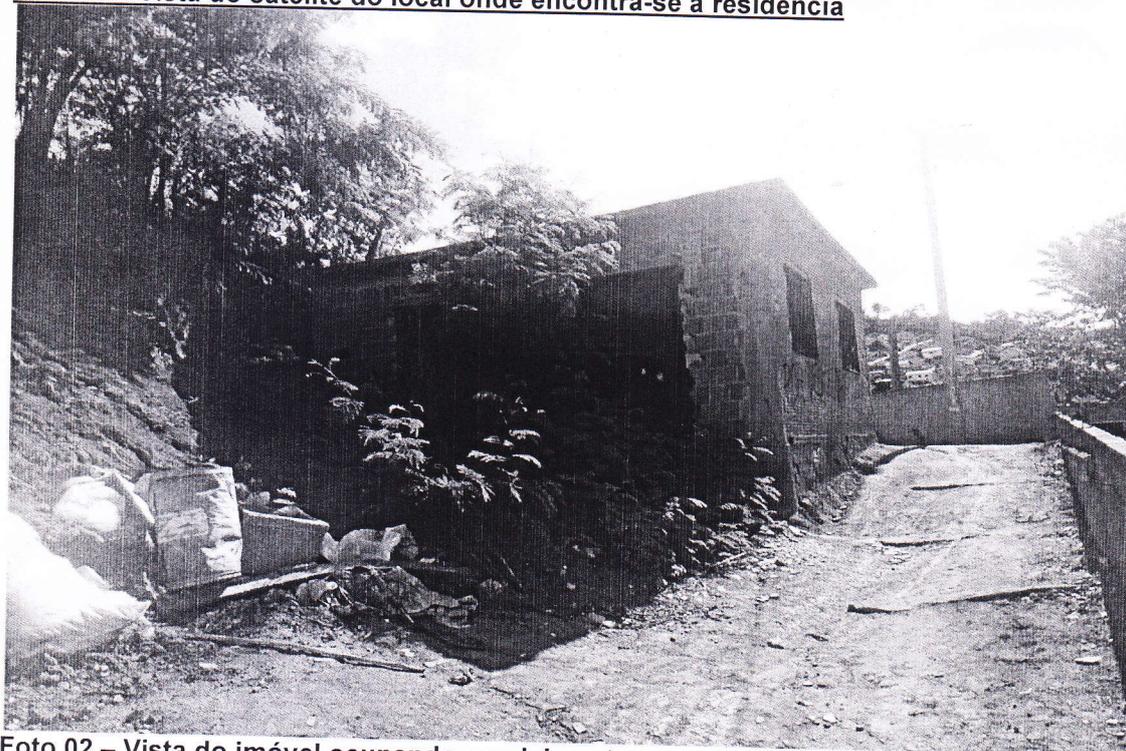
Vista do imóvel ocupando parcialmente a rua (subindo)
